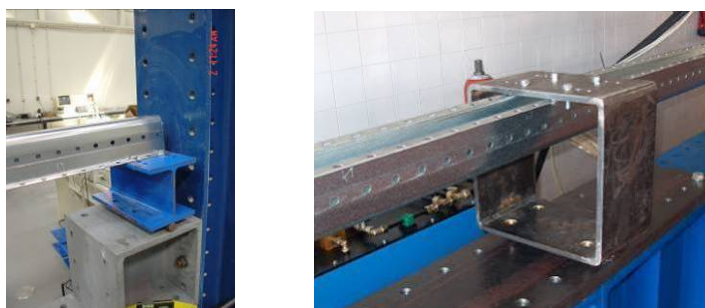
Perfil de apoio do tipo H e do tipo tubular.
